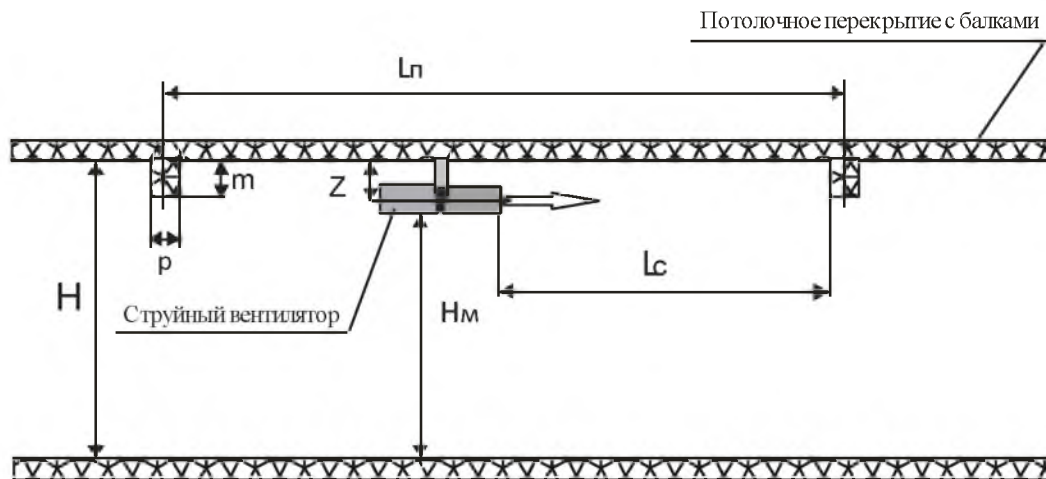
Схема установки струйного вентилятора на потолочном перекрытии, где
